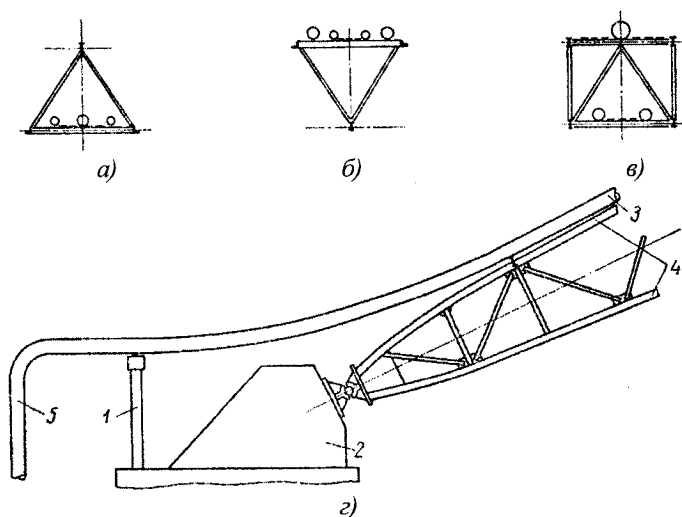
Схема, за якою трубопровід не бере участі в роботі аркового переходу: а – трубопроводи розташовані всередині трикутника; б – трубопроводи лежать зверху ферми; в – трубопроводи лежать всередині і ззовні ферми; г – загальна схема арки переходу; 1 – опора компенсатора, 2 – опора аркового переходу, 3 – робочий трубопровід, 4 – несучі аркові ферми, 5 – компенсатор
